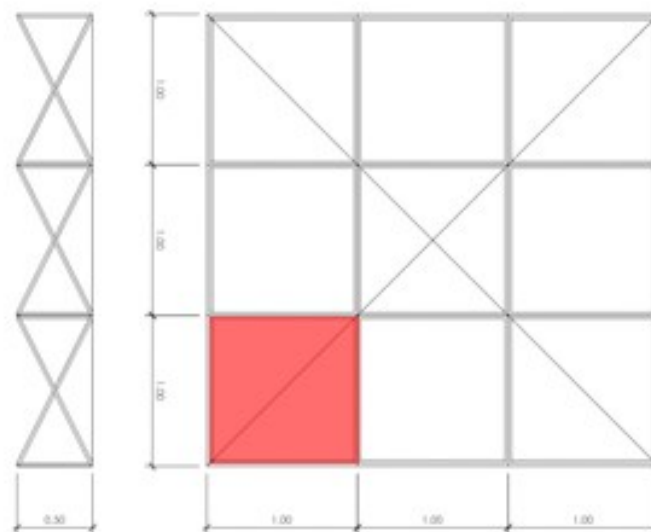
· Proyecto de estructura plegable planteada a los alumnos y modulo tipo
